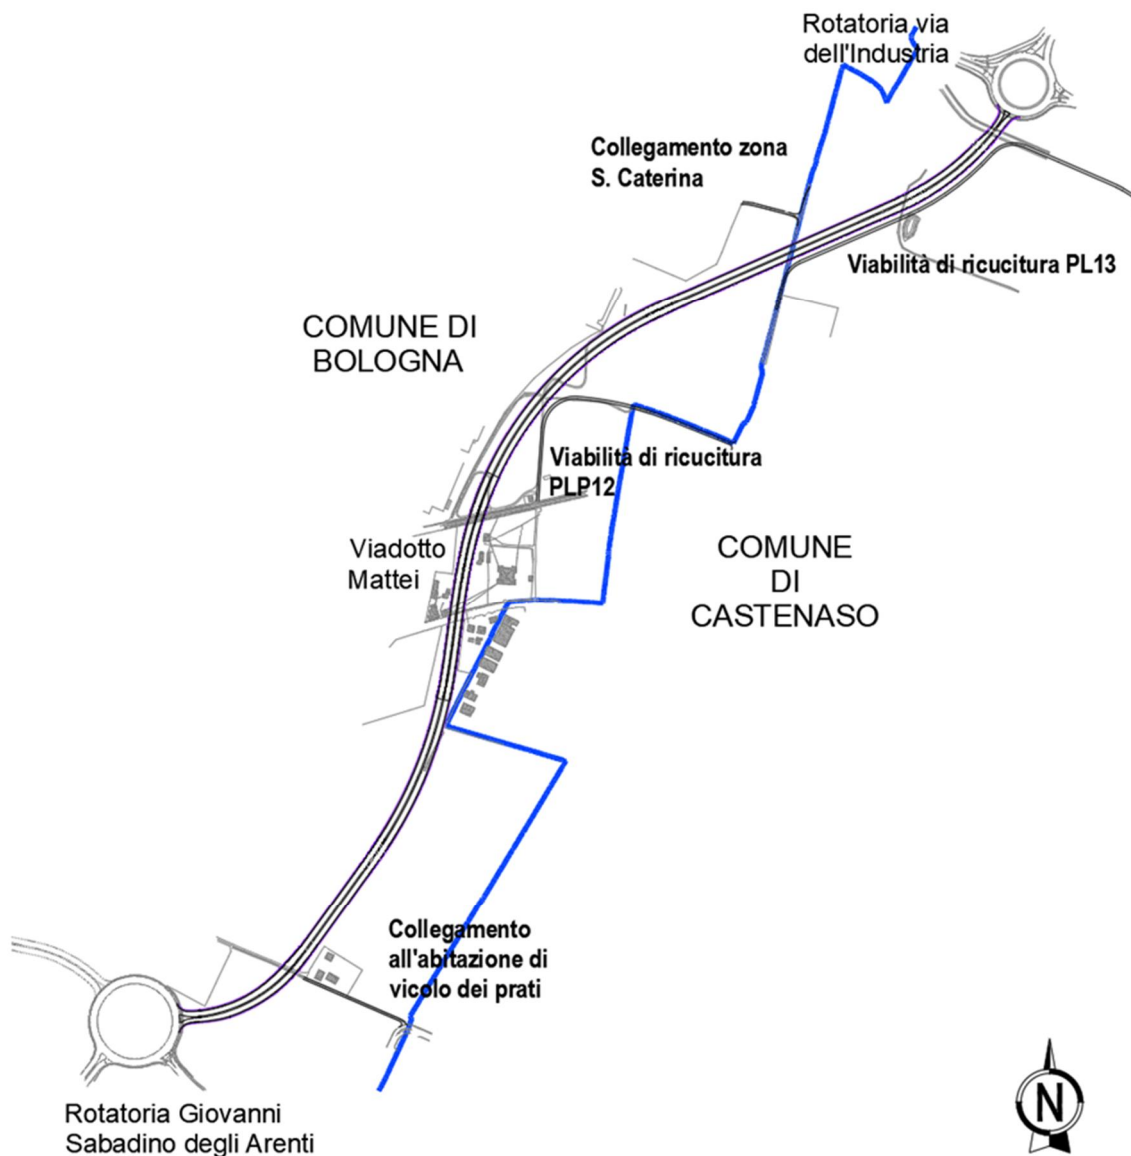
Planimetria schematica della strada Lungo Savena III lotto.
